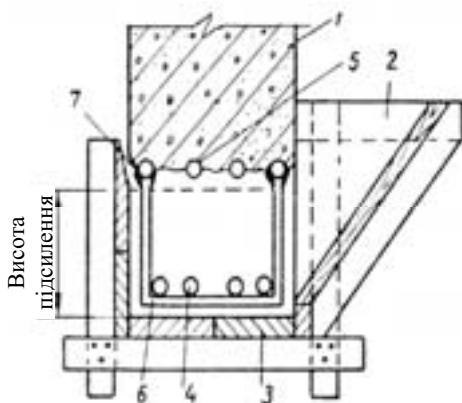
Підсилення залізобетонних балок (опалубочна схема);
